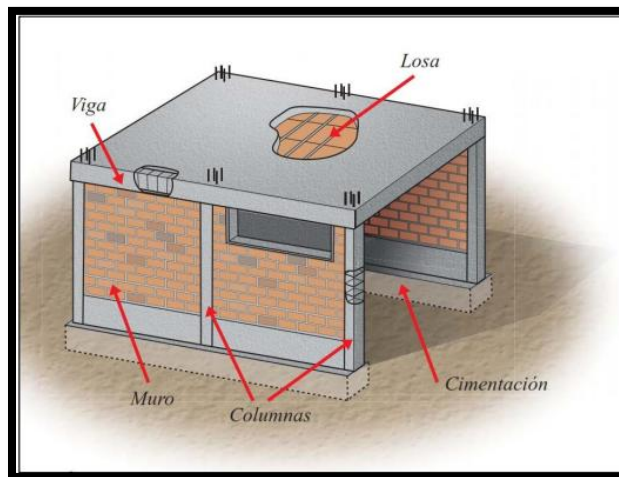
Elementos estructurales. Fuente: Uribe (2017)
